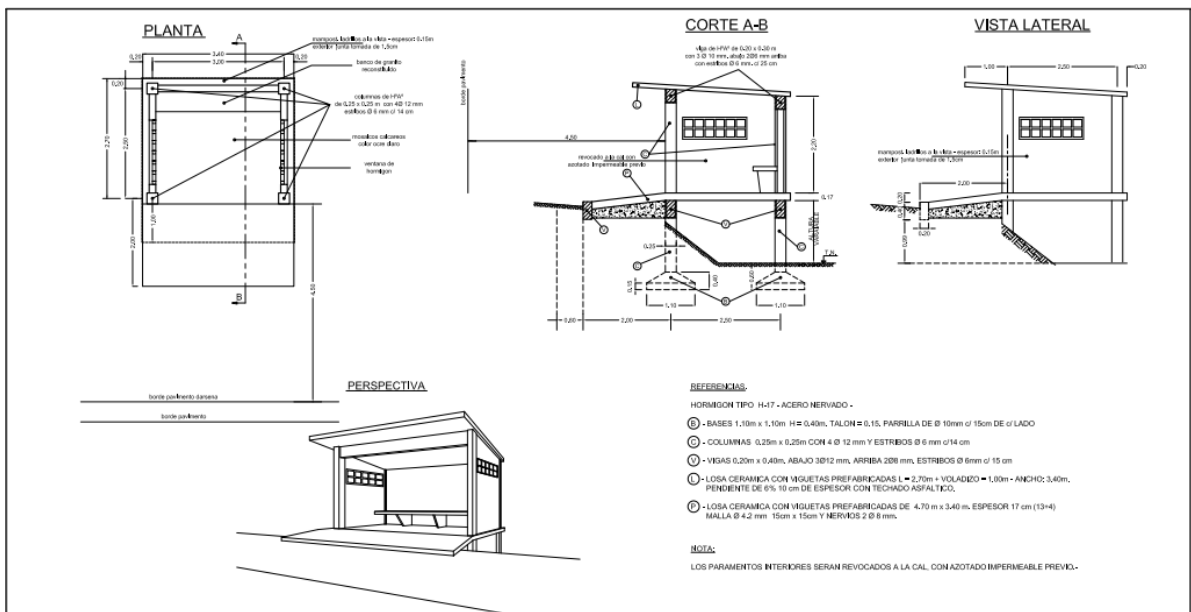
Plano tipo de refugio - Fuente: DNV
